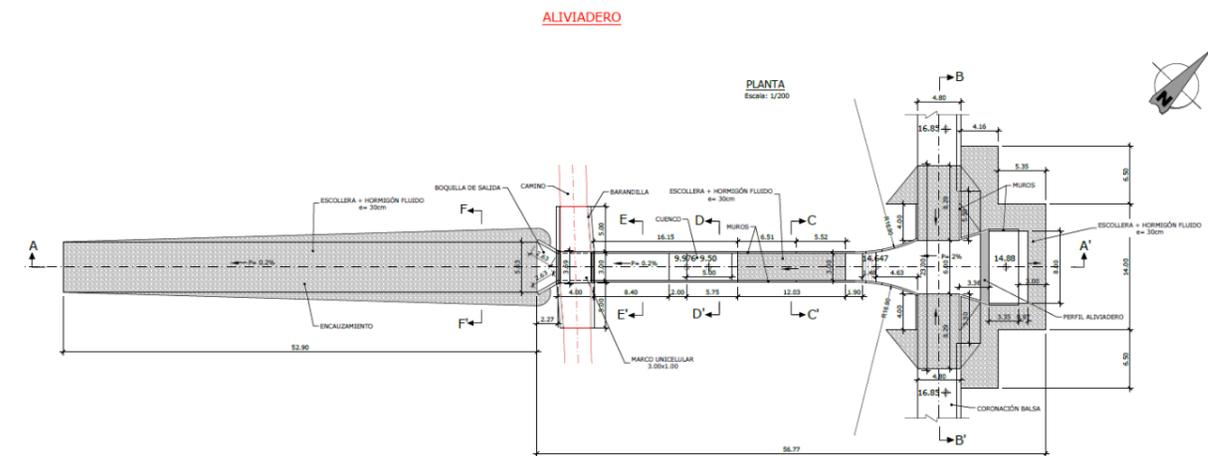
Aliviadero bolsa de regulación. Planta. S, Alcantarillas
